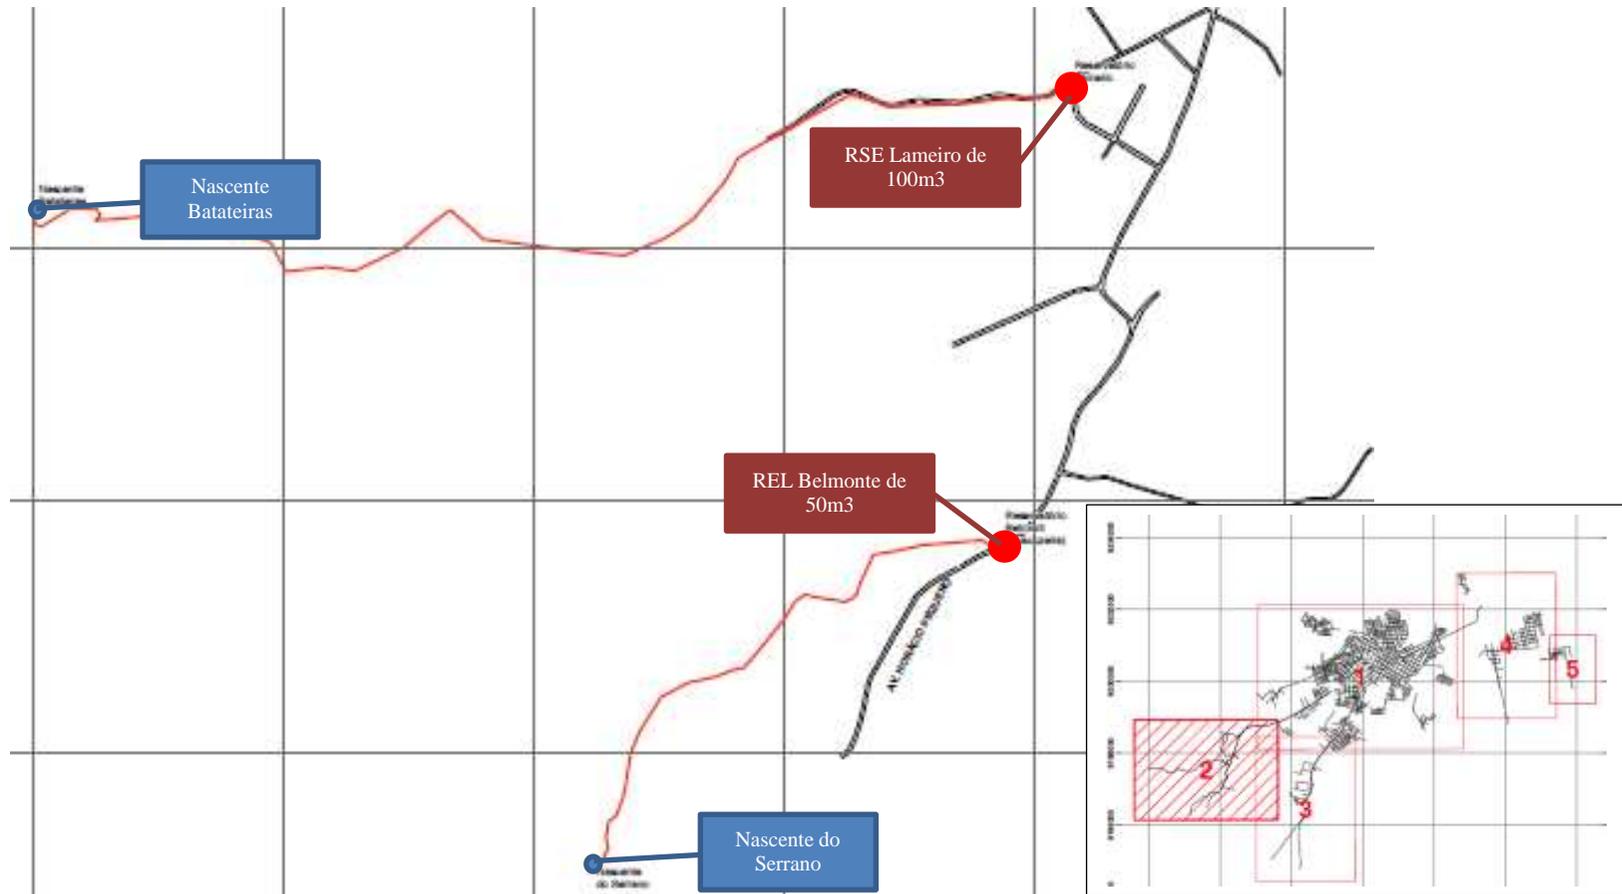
Croqui do sistema de abastecimento de água da sede do Crato.
